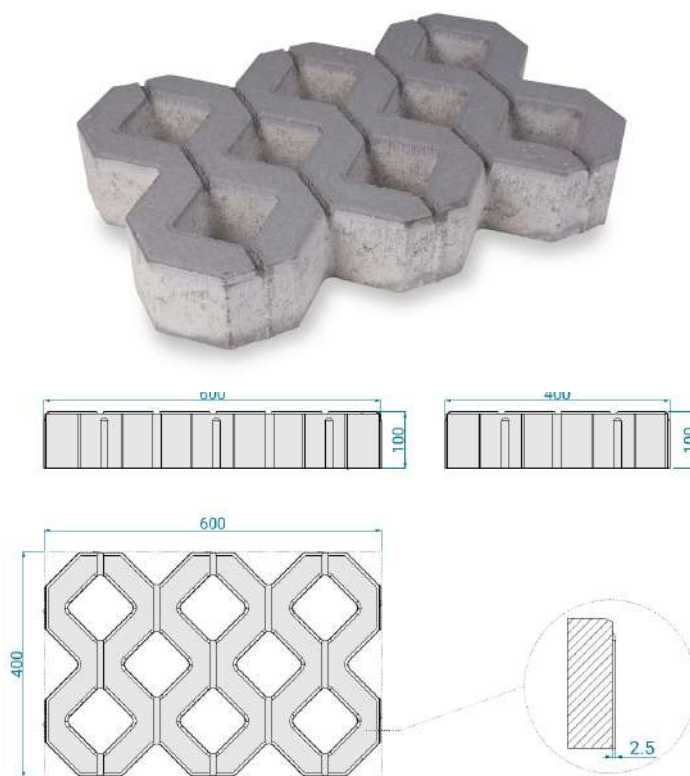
| Fotografía de pavimento drenante en celosía Nature.
